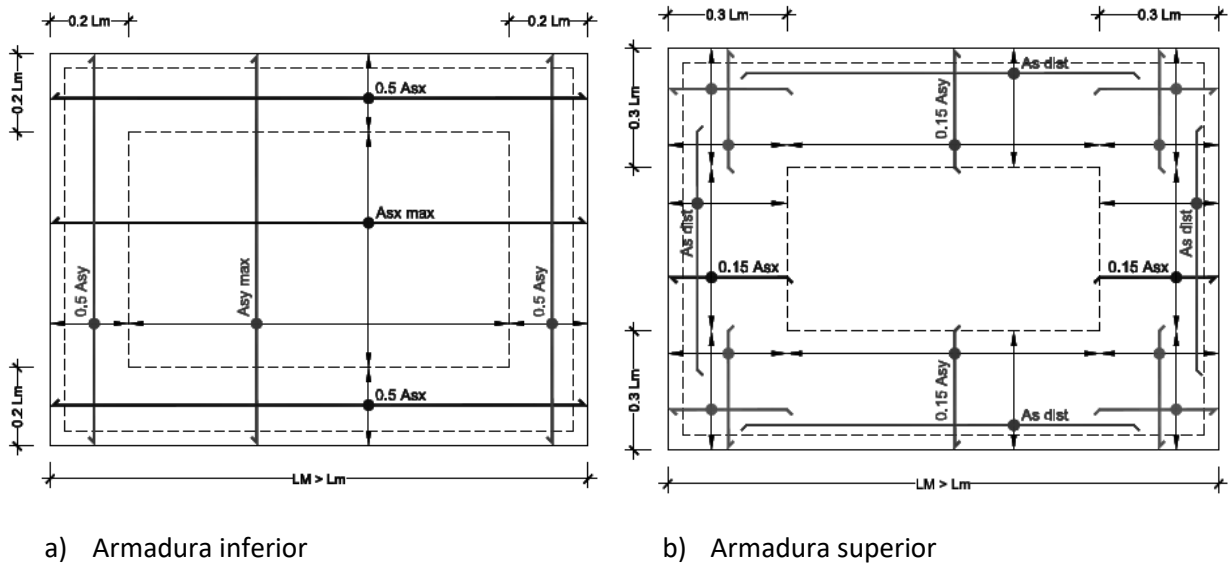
Disposições de armaduras de lajes simplesmente apoiadas
